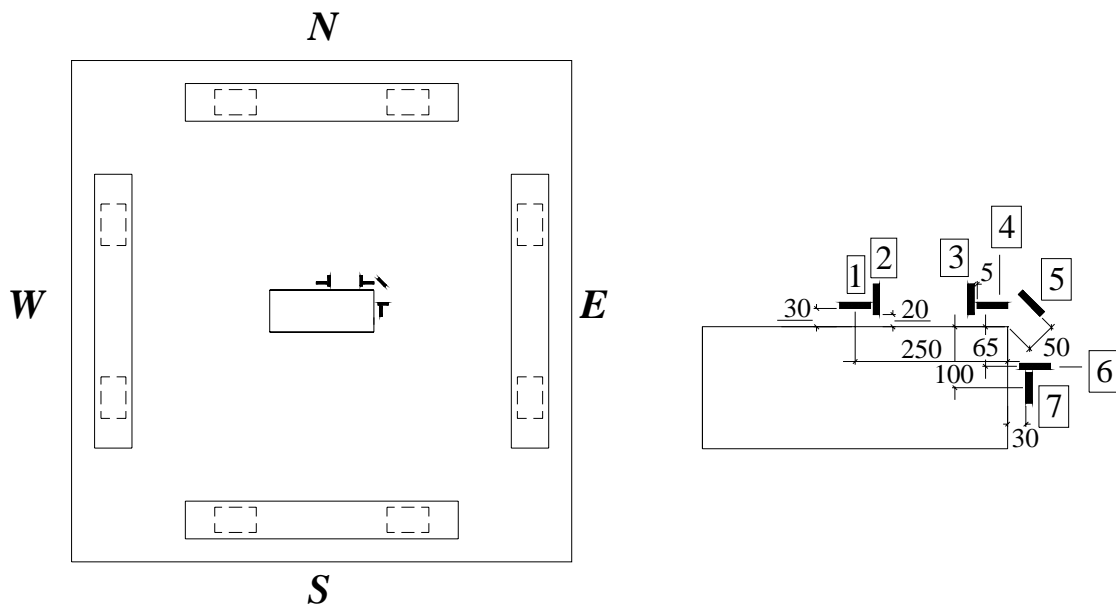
Posicionamento dos EERs do concreto nas lajes L14 e L15 (mm)
